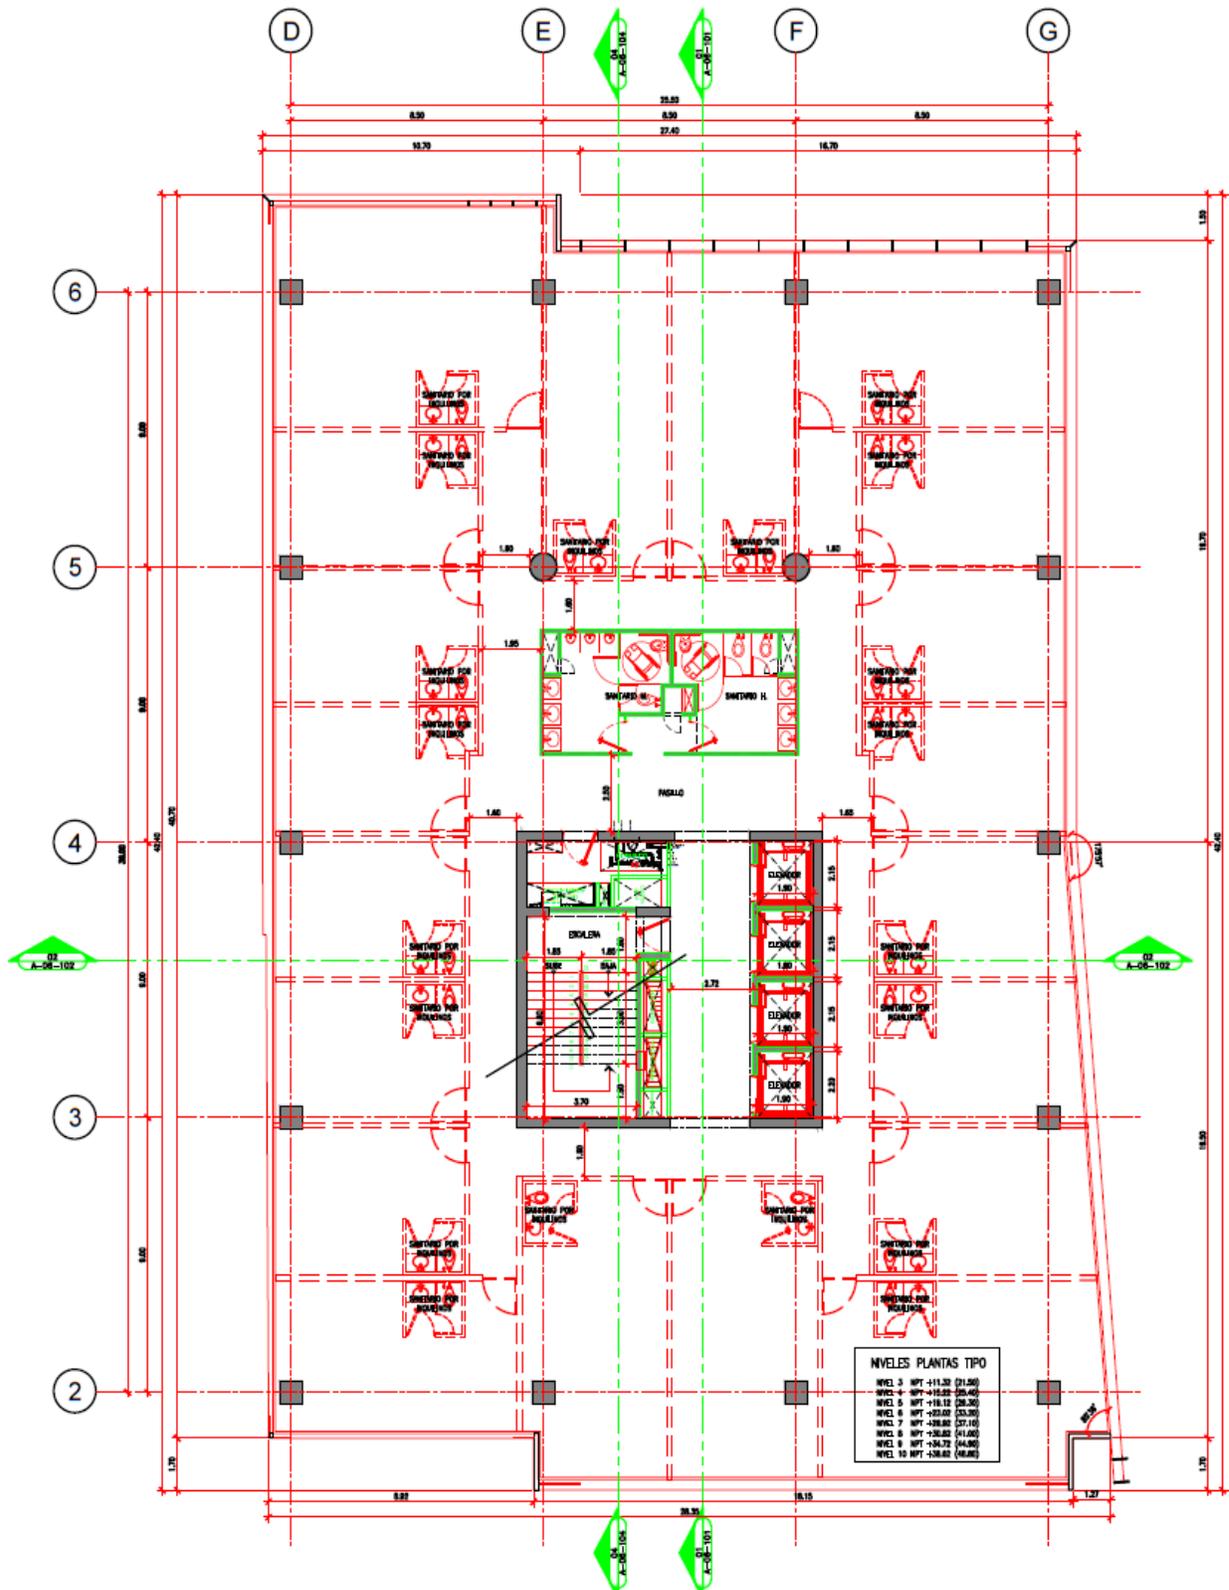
PLANTA NIVEL 3-10 (OFICINAS).
